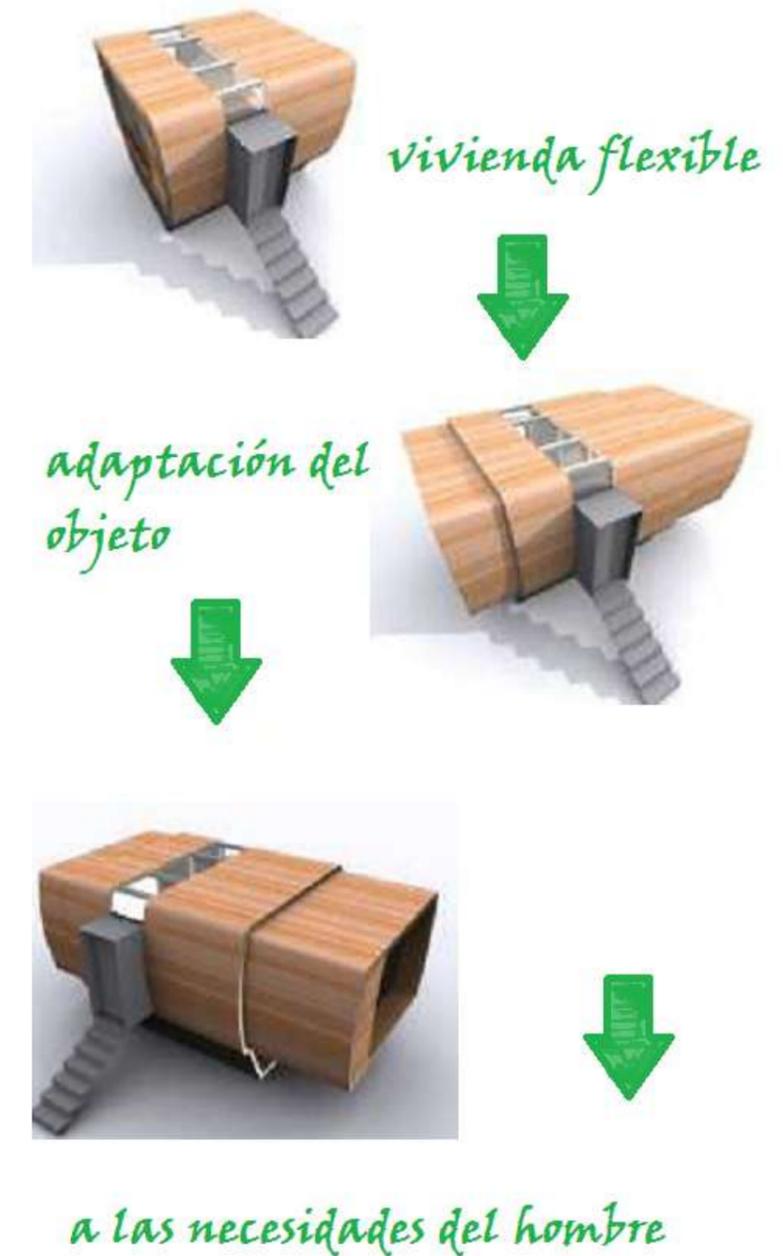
Sistema Telescópico Aplicado a la Arquitectura
